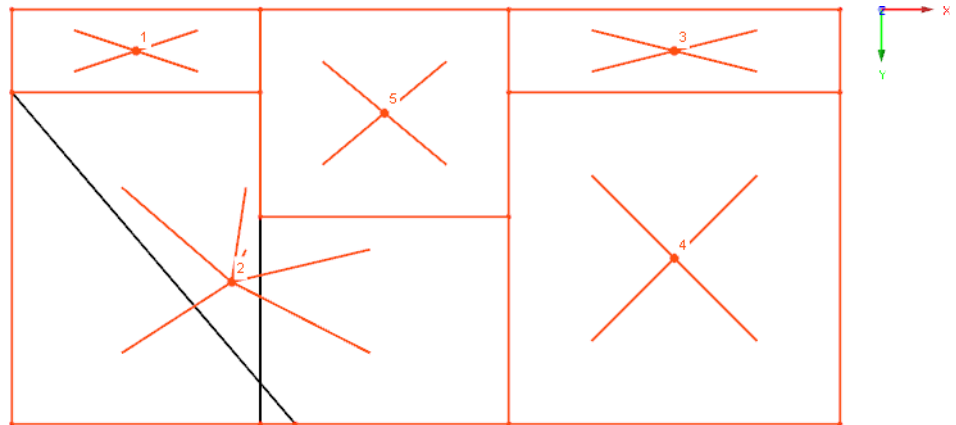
Bühnenkonstruktion mit Zellen für Lastgenerierung
